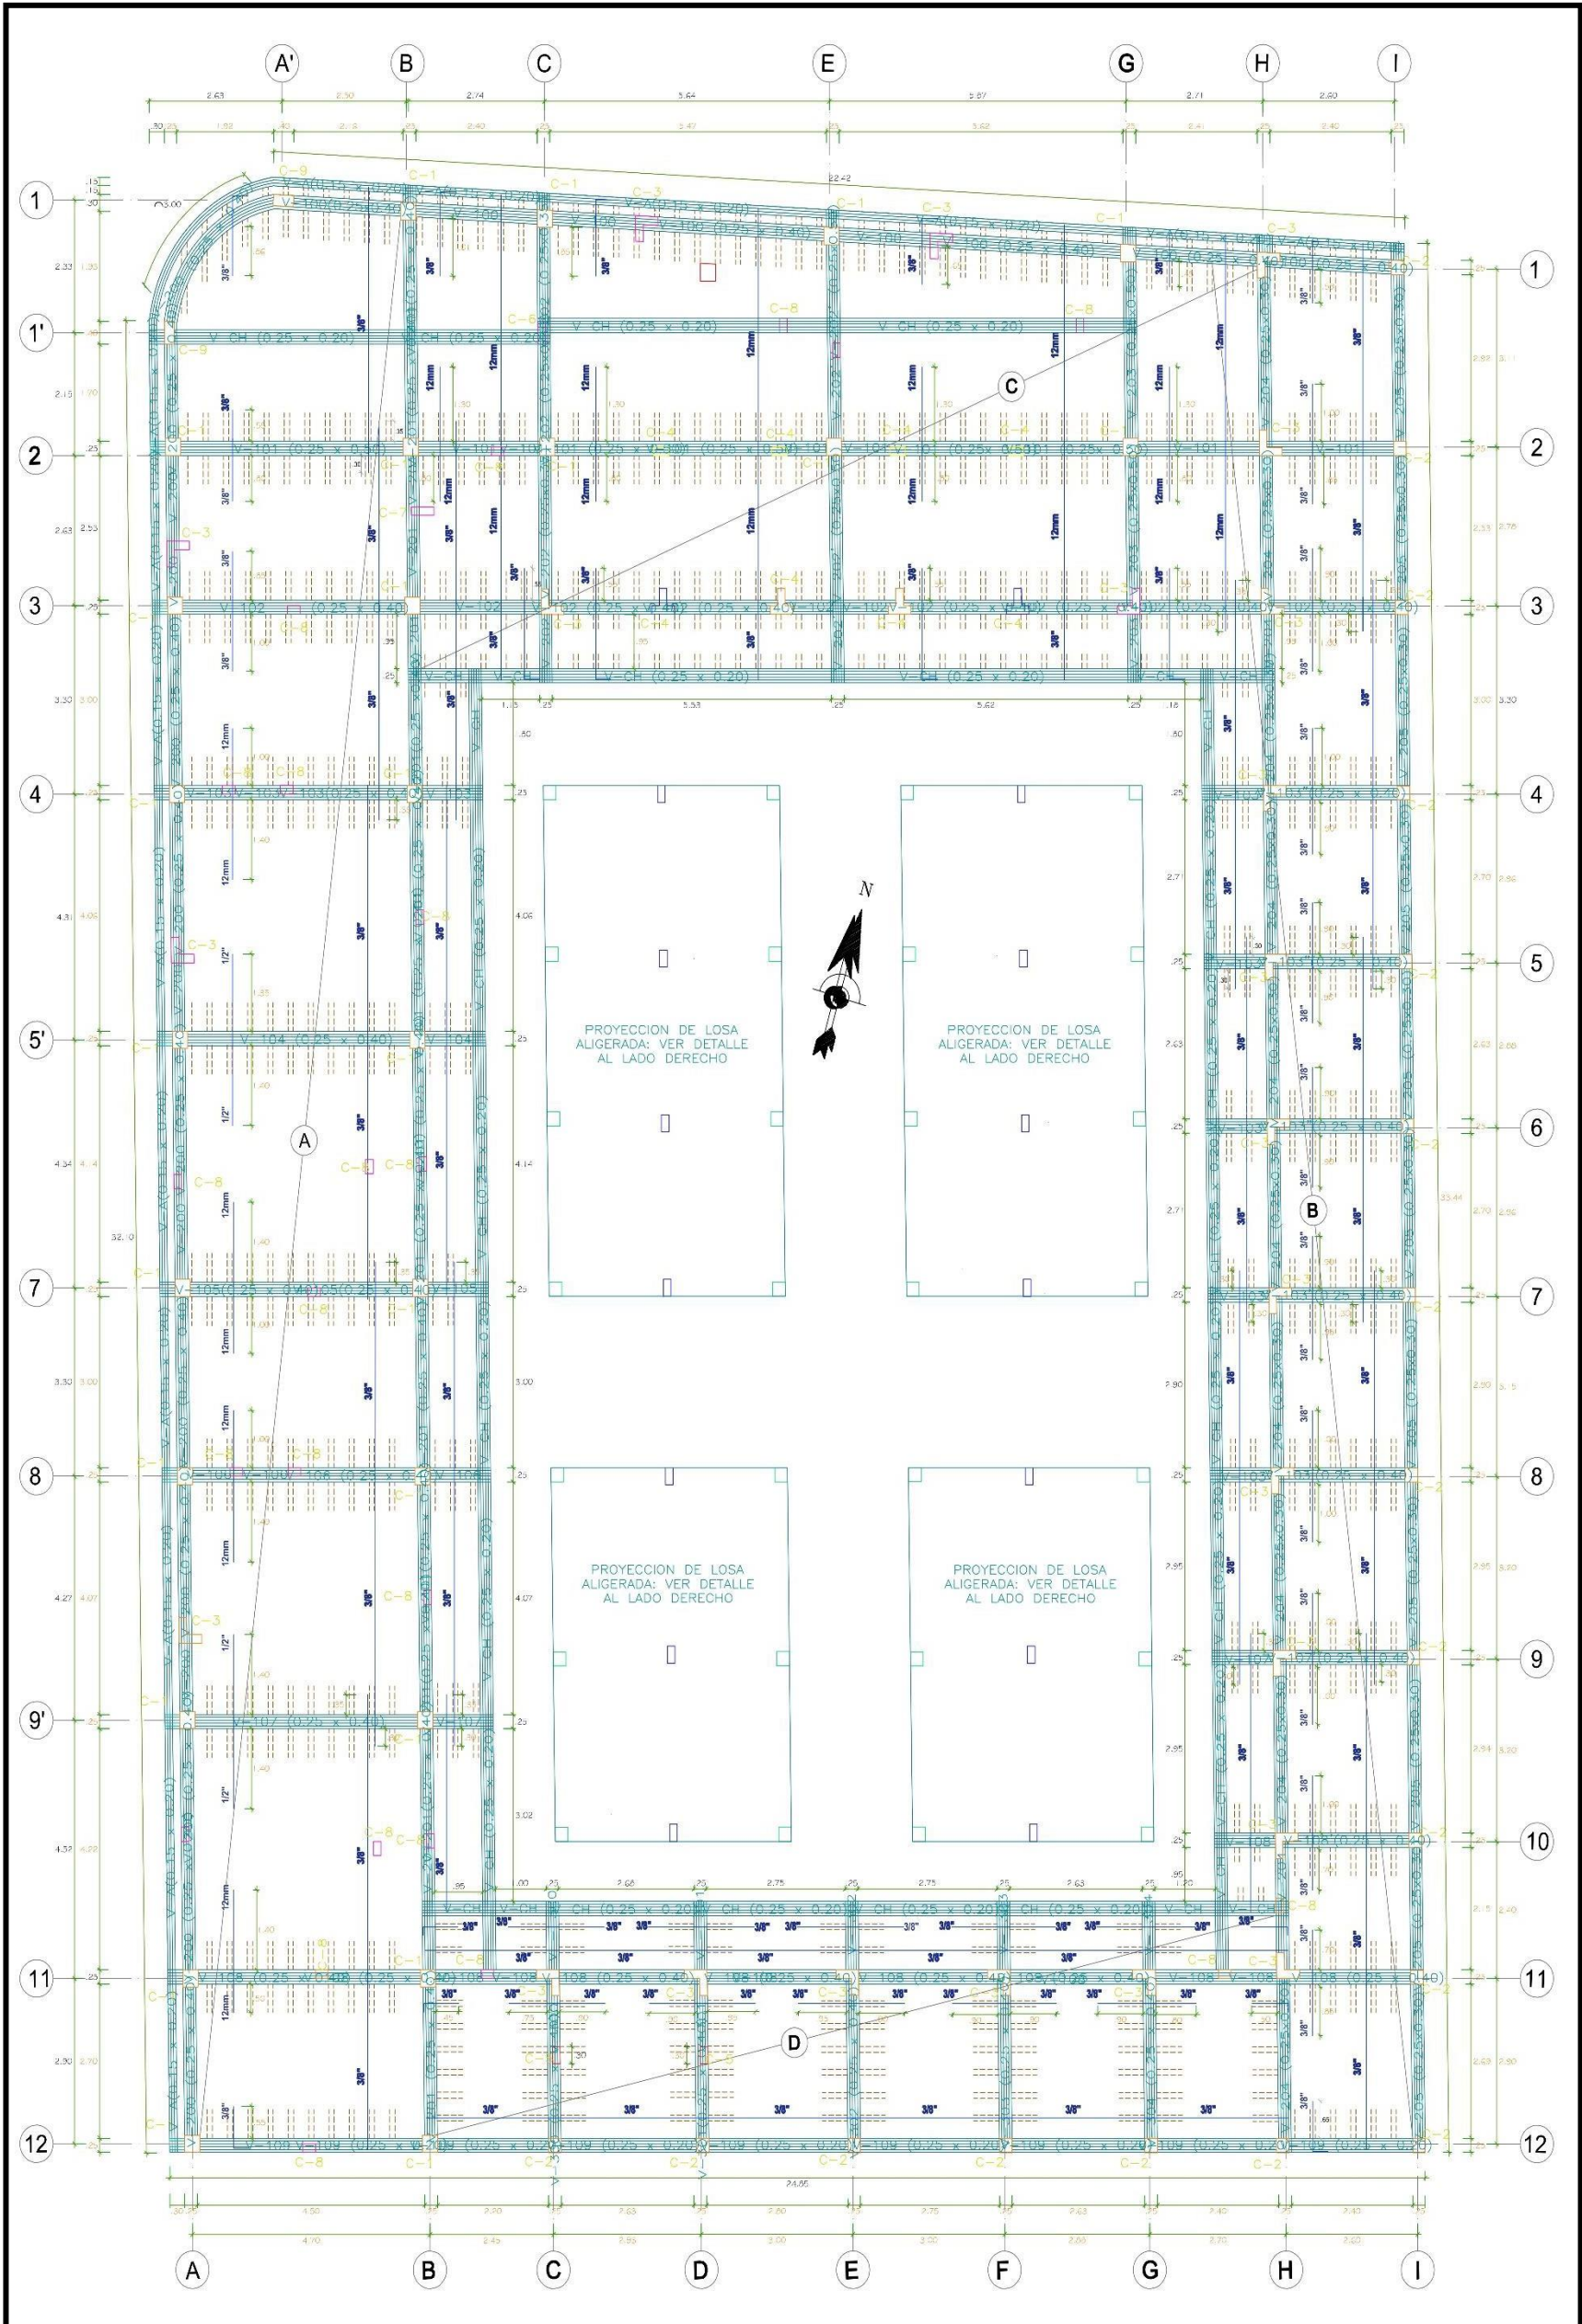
Plano de estructuras cimentación – Vista en Planta.
